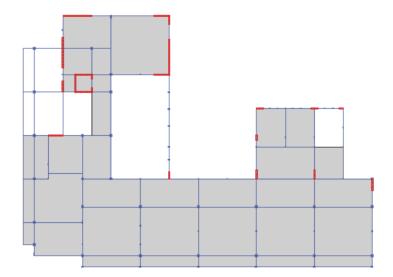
Planta segundo piso, Liceo Politécnico Pitrufquén.
